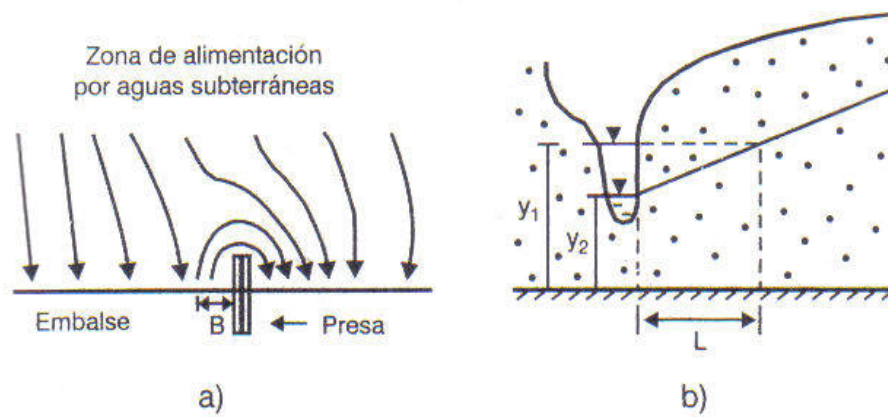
Esquema de cálculo de la filtración en áreas de la presa, a) planta; b) perfil.
